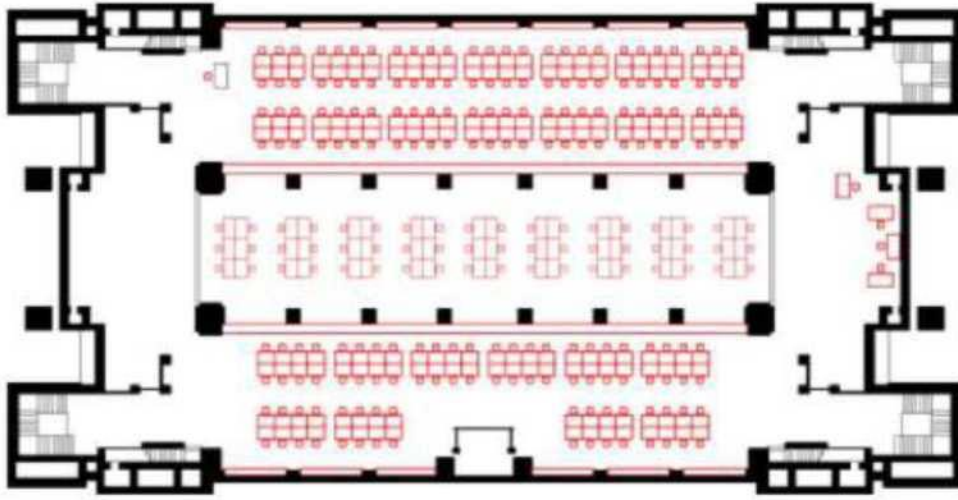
Gruner ve Jahr Binası Planı (Louis Sullivan)
